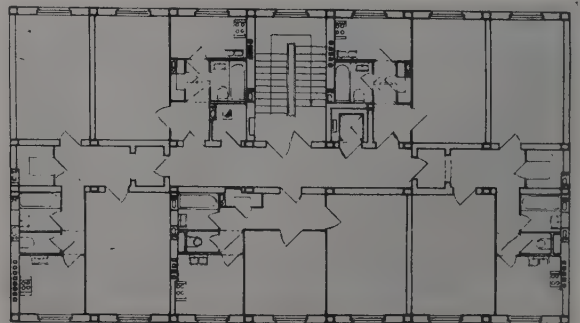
(links) u. 6 (rechts): Typengrundrisse 1954 für Blockbauweise mit sechs bis sieben Geschossen
